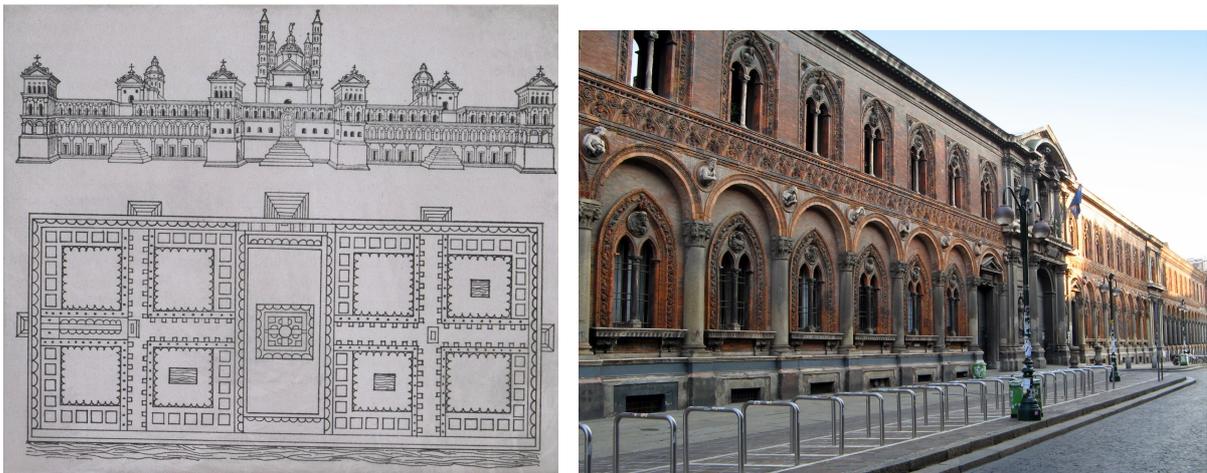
y 5.09 Ospedale Maggiore de Milán, Planta y Fachada Principal
